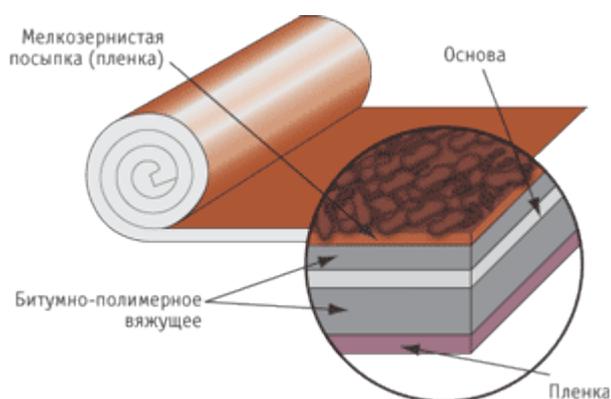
Устройство битумно-полимерной наплавляемой рулонной гидроизоляции
